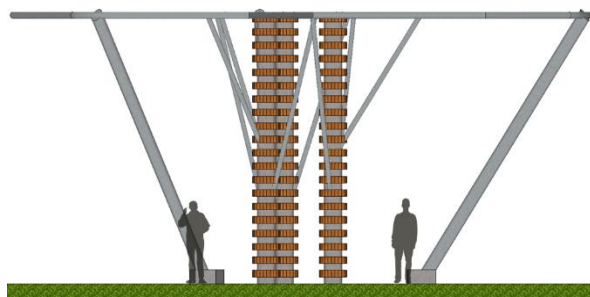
90. Tampak Depan Alternatif 1 Fasilitas Shelter
